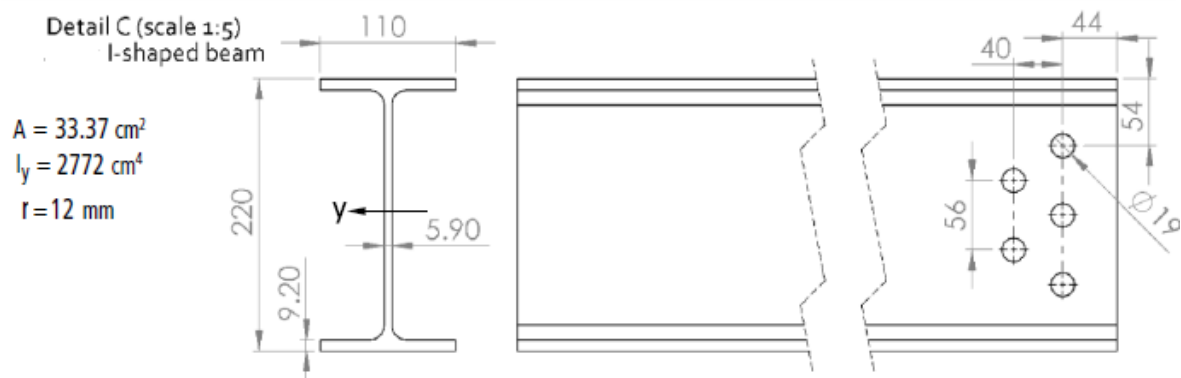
Geometria do perfil IPE220 e das ligações rebitadas [34] [81]
